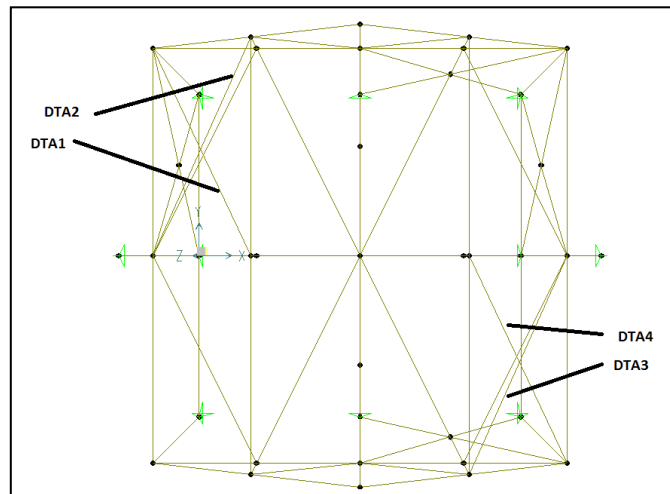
Vista de planta en perspectiva, altura a canoa, soportes diagonales paralelos al plano del techo
